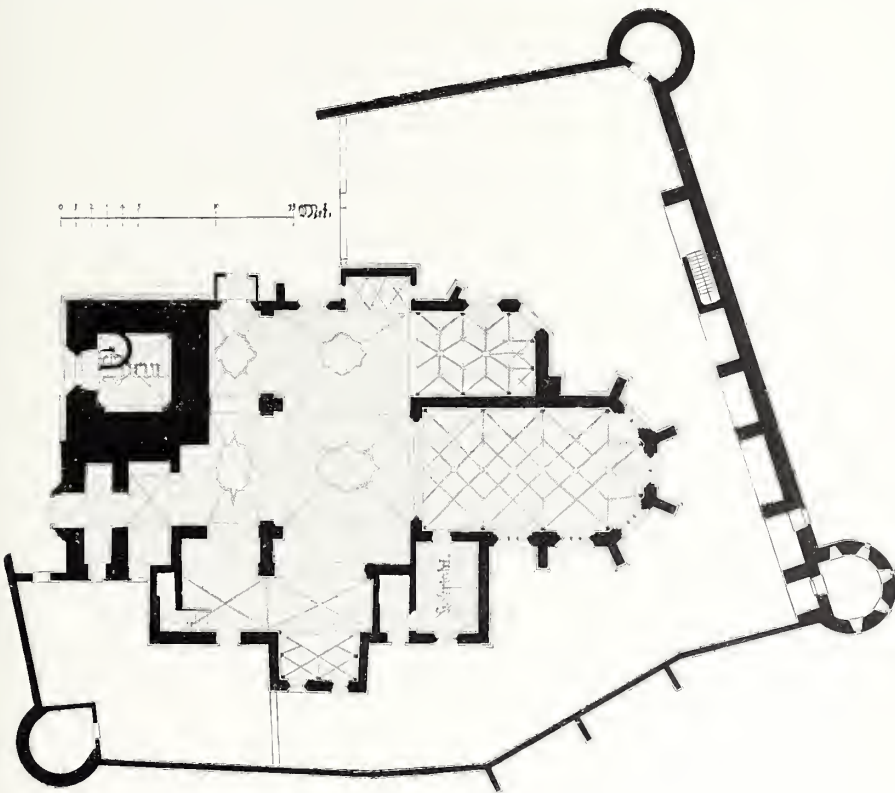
Weißkirchen, Pfarrkirche, Grundriß 1:500 (S. 554)
